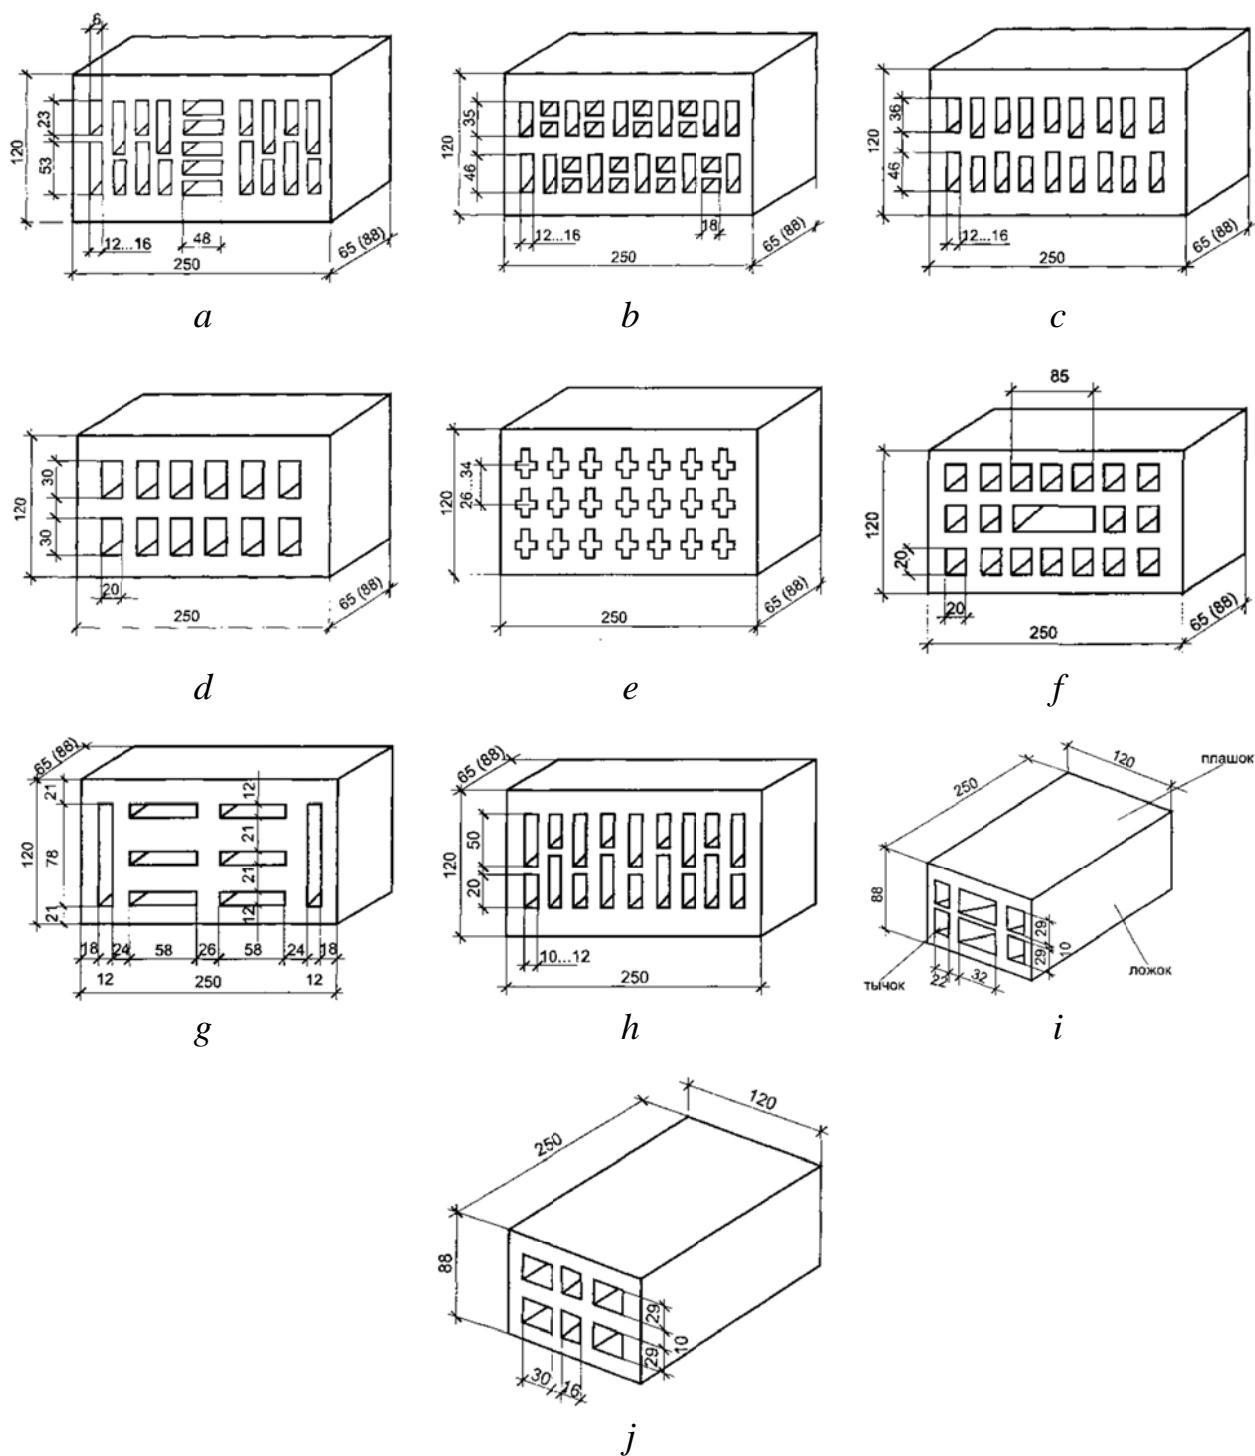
Кирпич с пустотами квадратной, прямоугольной и неправильной формы:
